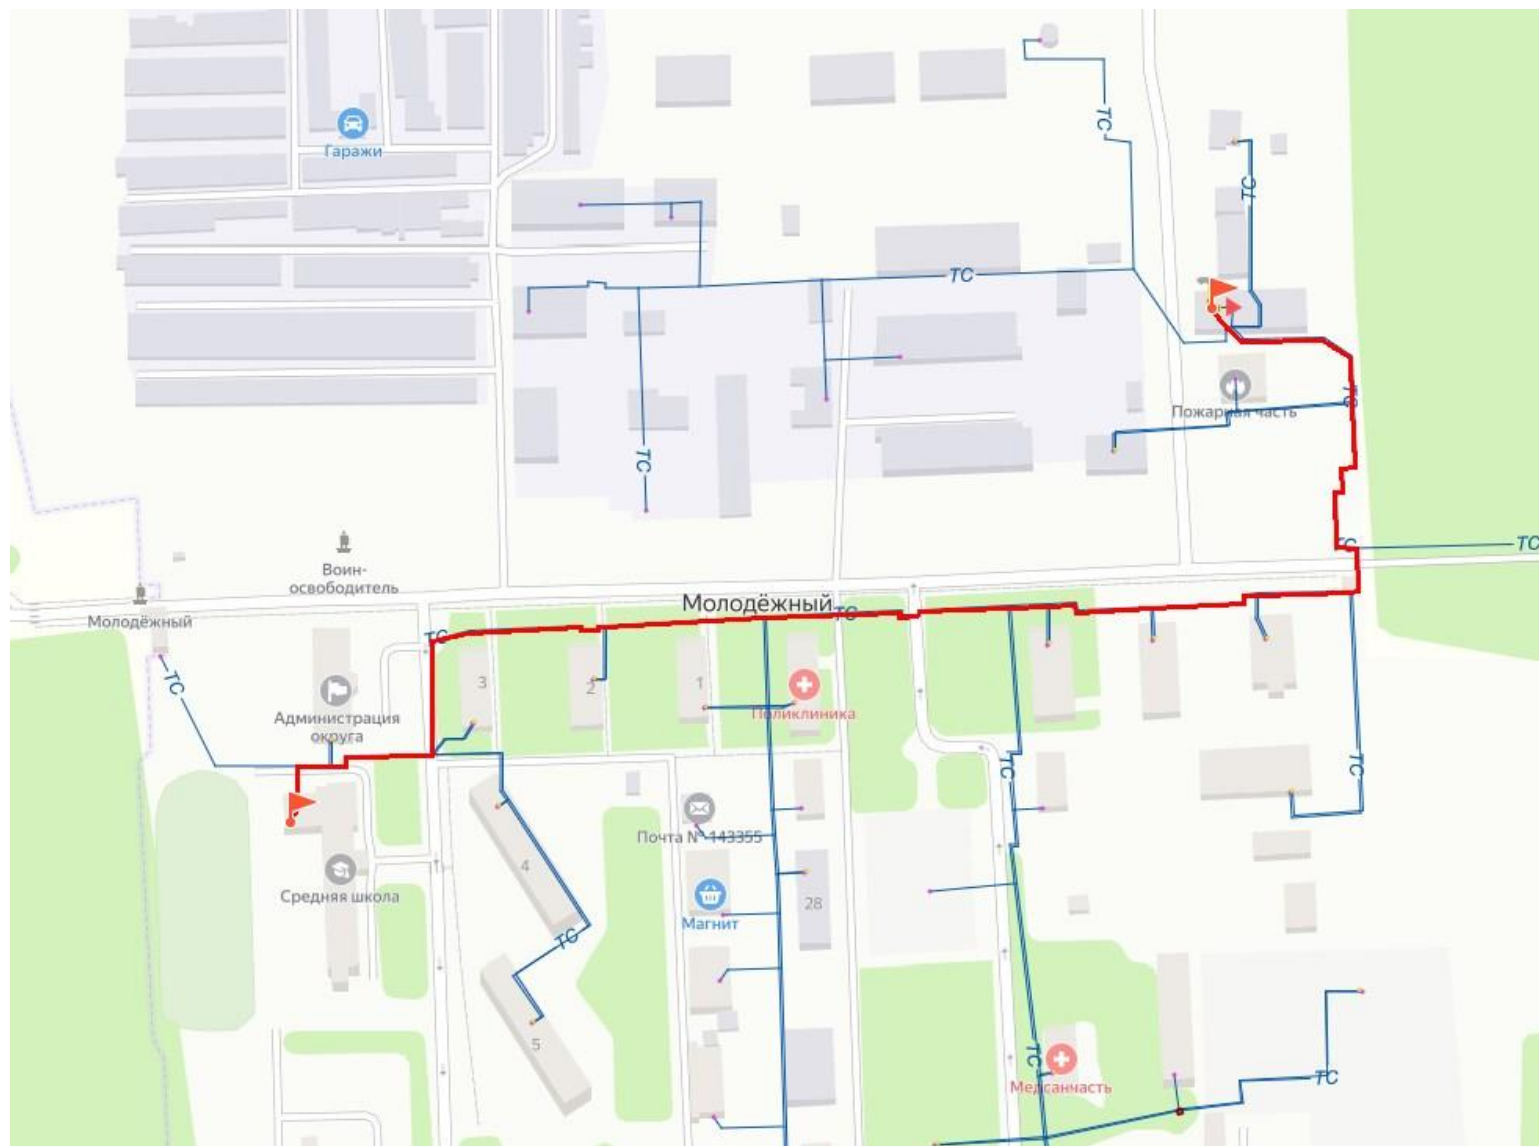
Схема тепловых сетей от котельной до МОУ СОШ.
